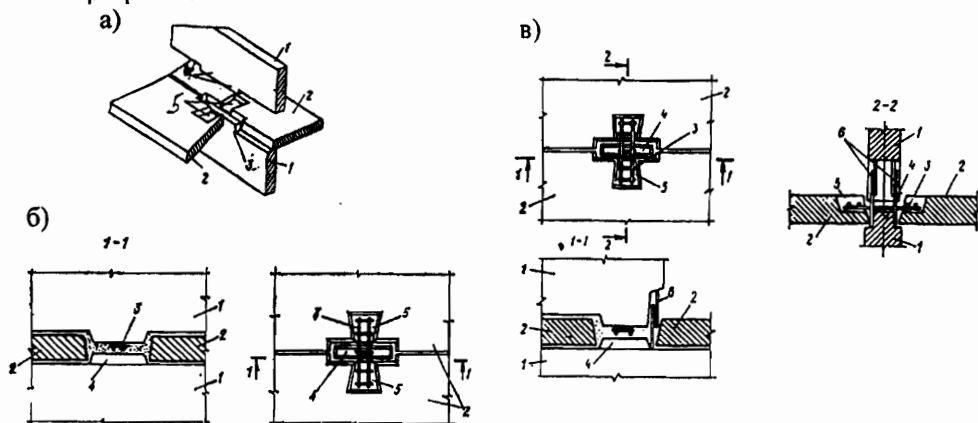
Сопряжение внутренних стеновых панелей и плит перекрытия: а – общая схема; б – без вертикальной связи; в – то же, со связями; 1 – внутренняя стеновая панель; 2 – плита перекрытия; 3 – арматурный каркас; 4 – шпонка стеновой панели; 5 – шпонка перекрытия «ласточкин хвост»; 6 – выпуски арматуры
